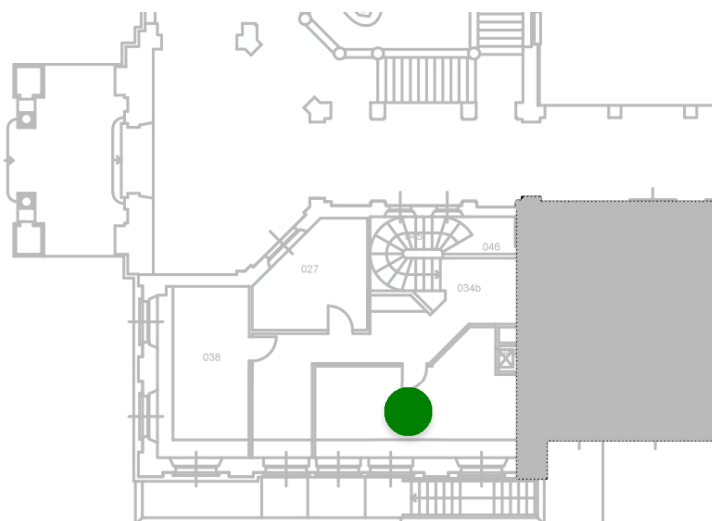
Ingrandimento zona interessata Pianta Piano Soppalco
